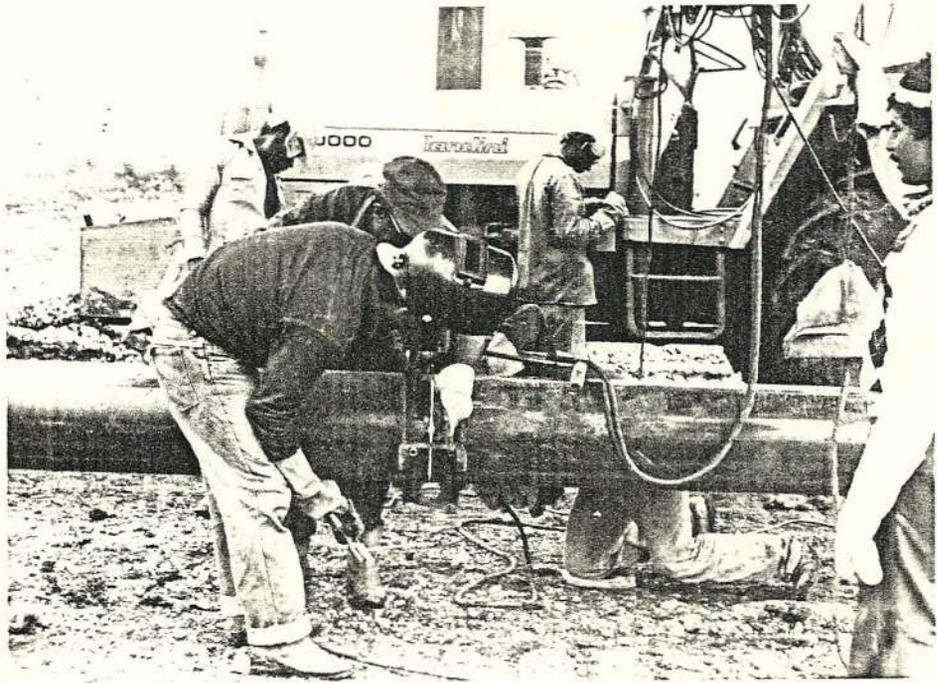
Ejecución del pase de raíz en cordón de soldadura para unión de tubería.
